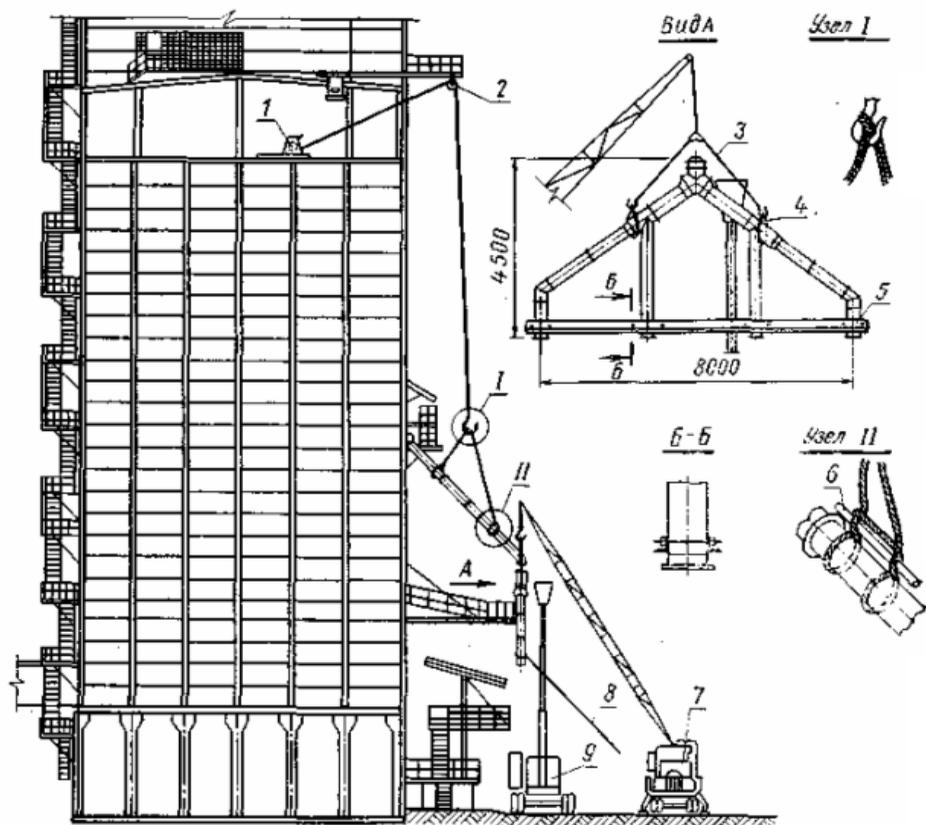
Монтаж наружного зернопровода, предназначенного для отпуска зерна в железнодорожные вагоны: 1 – лебедка ручная грузоподъемностью 1 т; 2 – блок однорольный грузоподъемностью 1,6т; 3 – строп УСК-2; 4 – строп УСК-1,0-2; 5 – стяжка (уголок равнополочный размером 63X X63X5 мм); 6 – закладная труба; 7 – автомобильный кран; 8 – оттяжка (канат пеньковый 20 мм); 9 – телескопическая вышка
